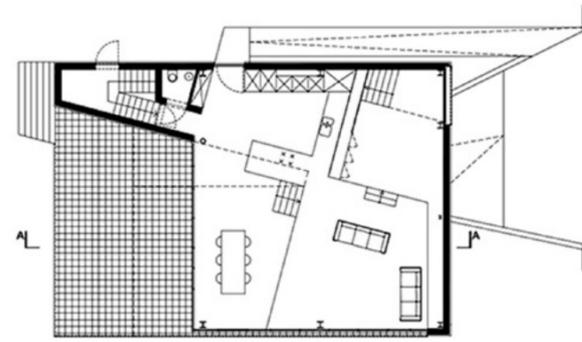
Grundriss des Hauses Leeuw / © NU architectuuratelier
